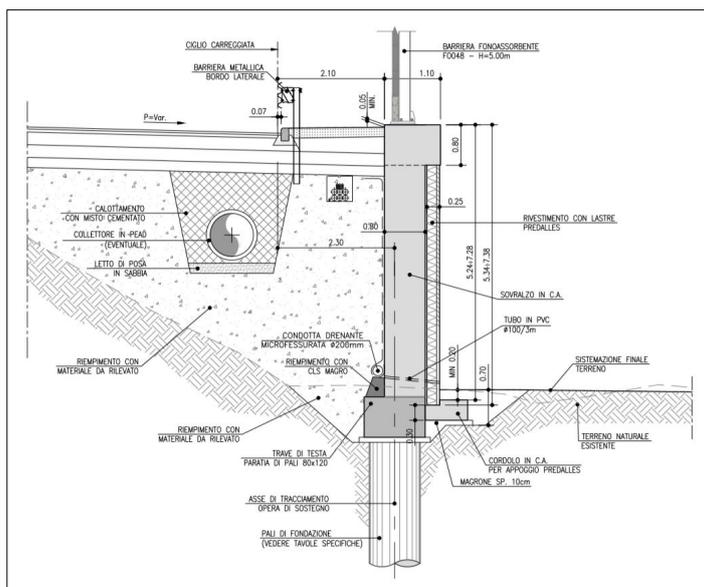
Sezione tipo dei muri di sostegno su pali di fondazione
